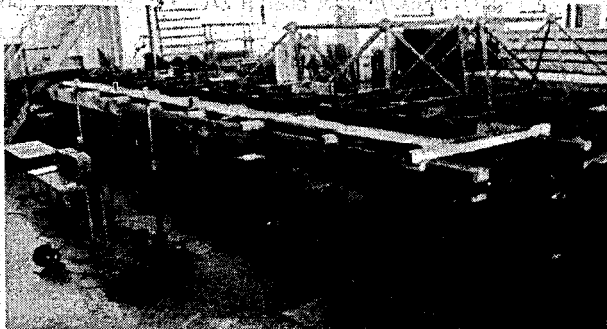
Блок из металлодеревянных ферм на испытаниях
